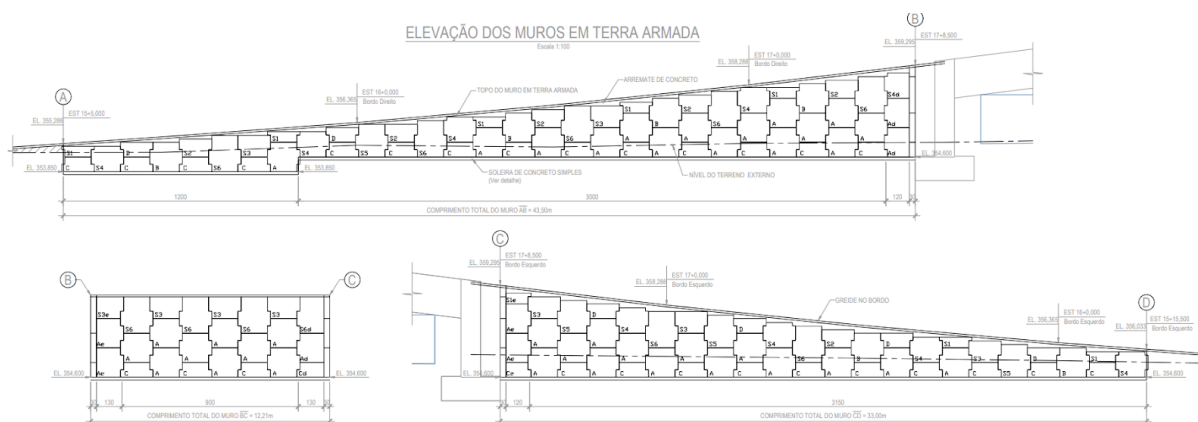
Perfil de elevação em Terra Armada do Viaduto do Complexo Viário Barra do Pirai (entre as estacas 15,00 a 17+8,50)
